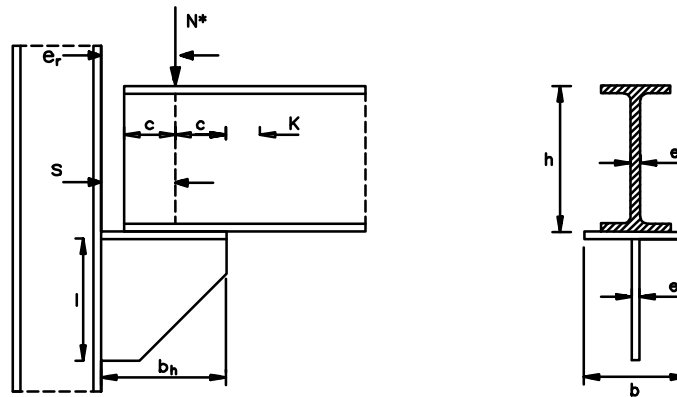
Alma de la viga y rigidizador en el mismo plano.
